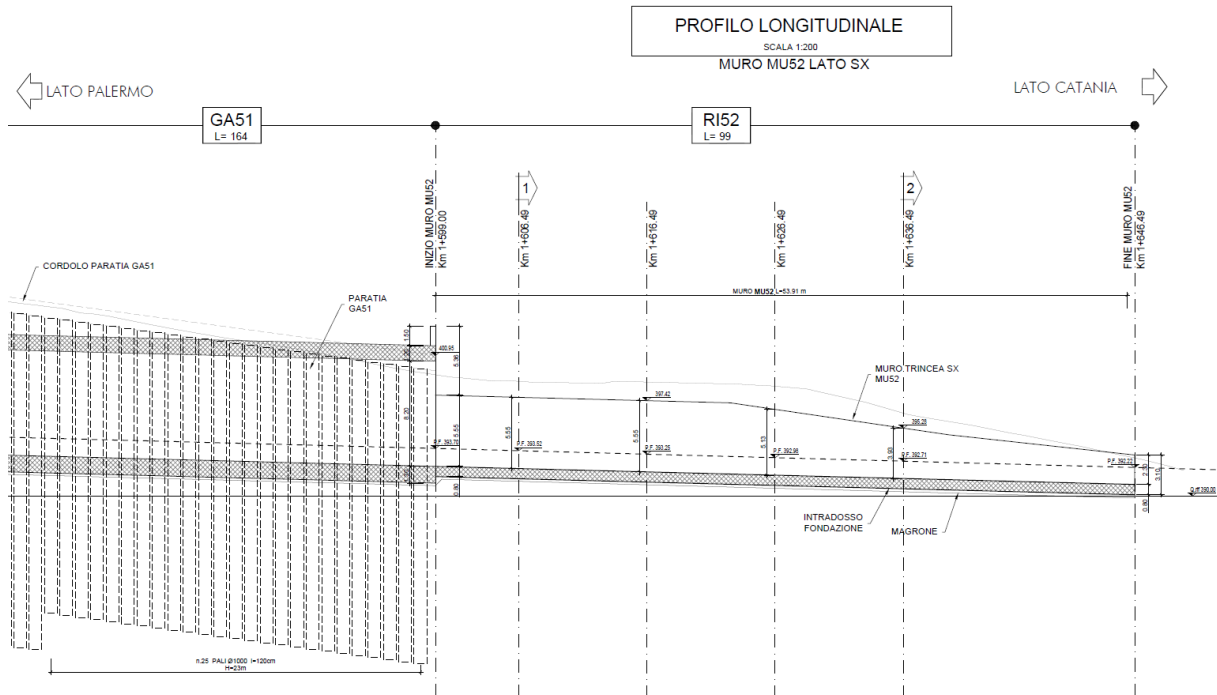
RI51: Muro a U MU52 – Prospetto lato sx.
